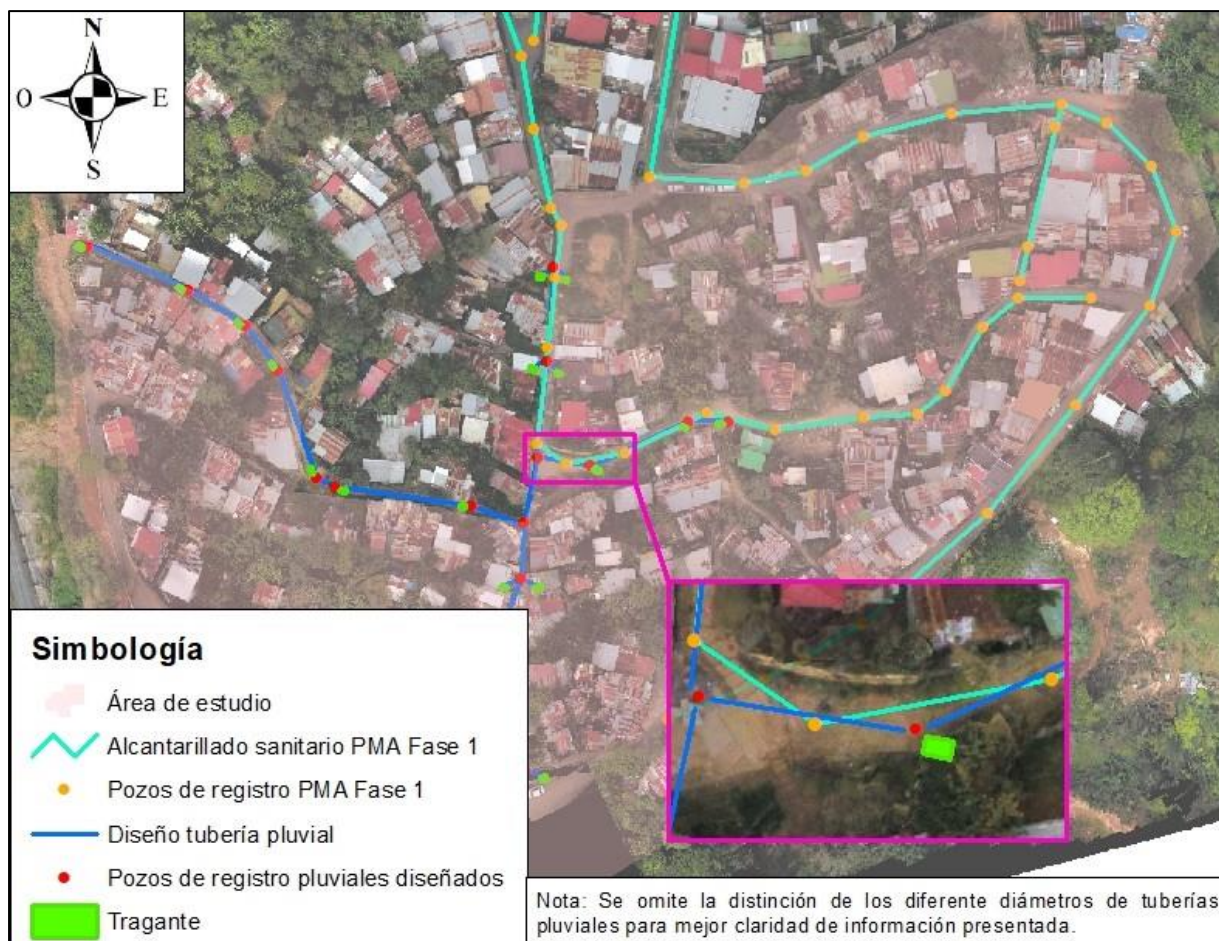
Alcantarillado sanitario PMA Fase 1 y alcantarillado pluvial diseñado en Miravalles
